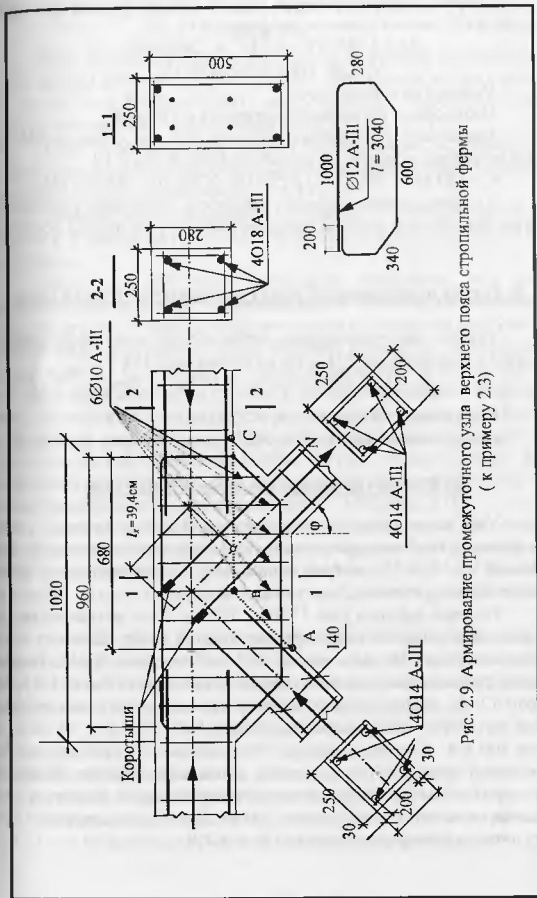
Армирование промежуточного узла верхнего пояса стропильной фермы (к примеру 2.3)
